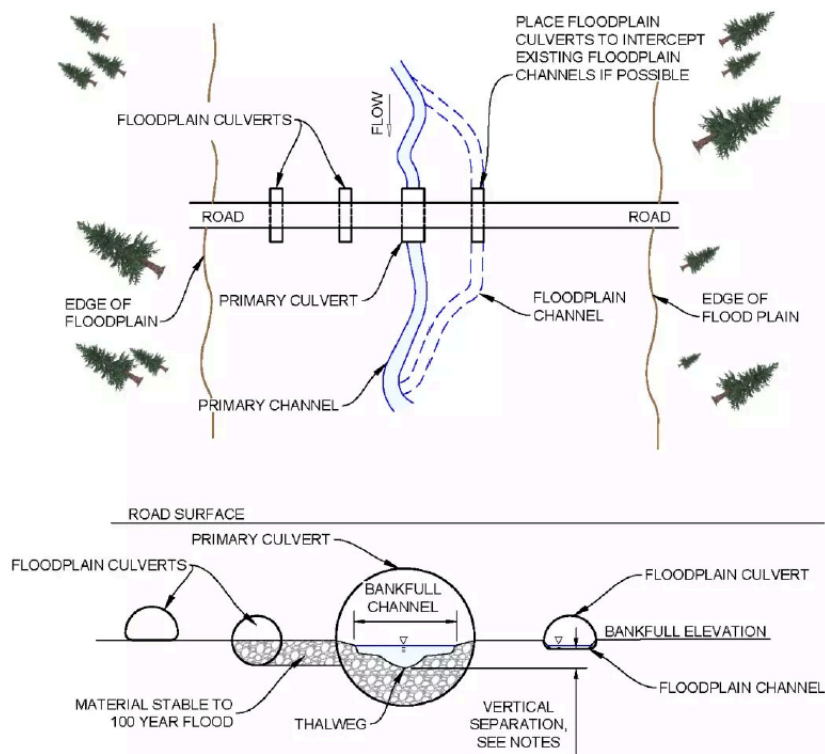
20. Esquema en planta y de la sección transversal de un atraveso con alcantarillas en la planicie de inundación. Fuente: <https://www.fws.gov/alaska-culvert-design-guidelines>.
